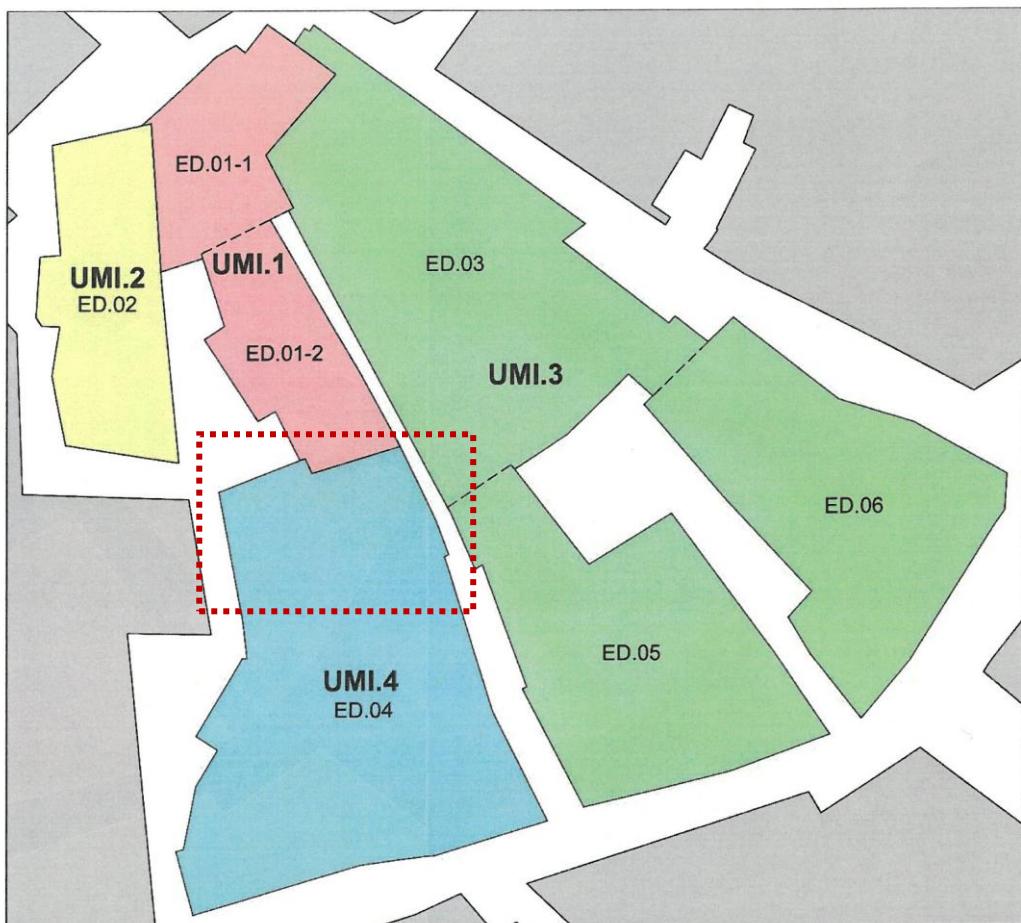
Planimetria d'insieme delle U.M.I. e degli ED dell'aggregato VSA16
